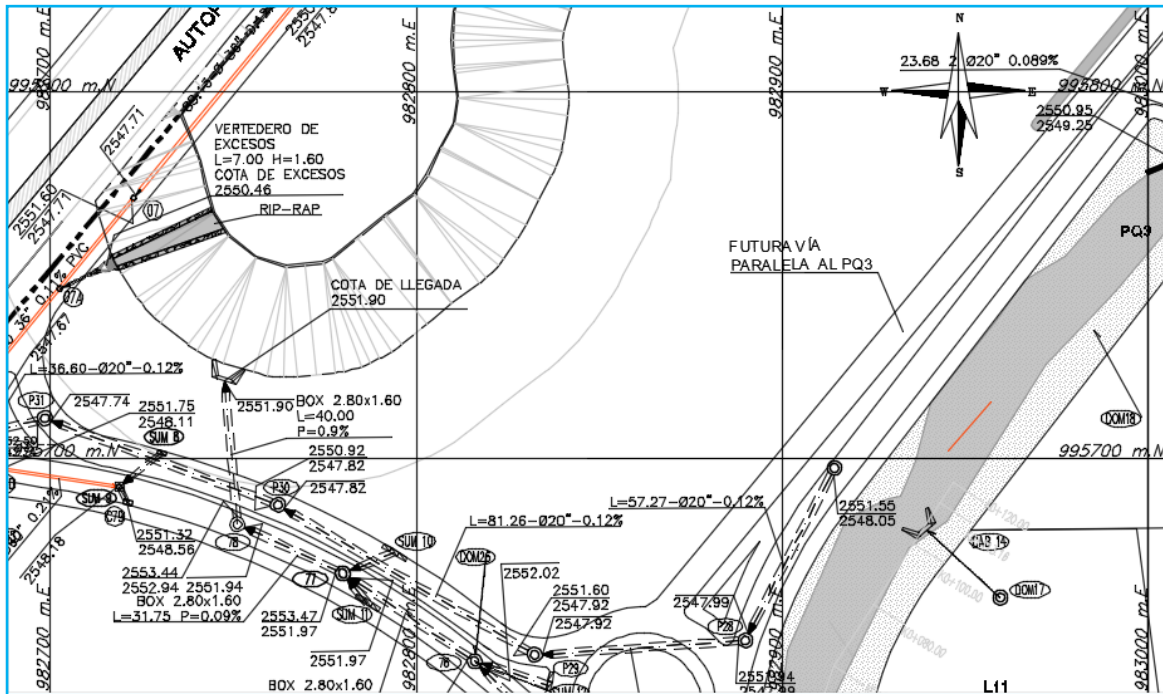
Alimentación del Humedal Cola de Tierra Blanca Mediante Box Culvert de Alcantarillado Según Plano 03/07 de la Propuesta Para Escenario Futuro.
